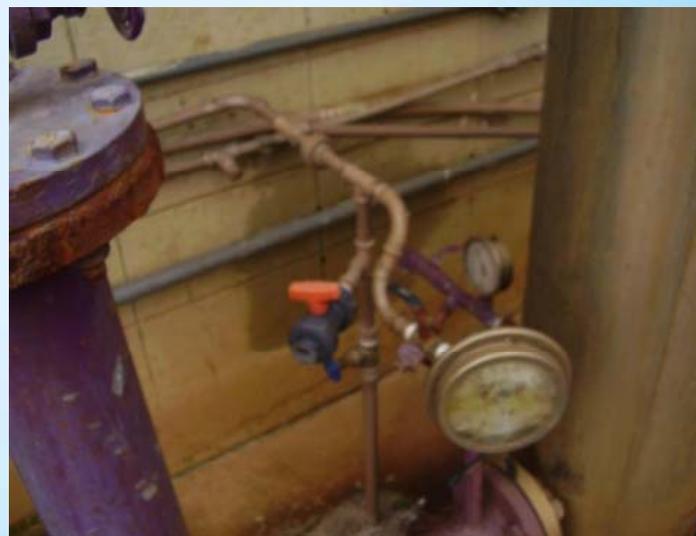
Ponto de alimentação e interligação da recirculação. Manômetro c/ menor divisão 0,10bar.
